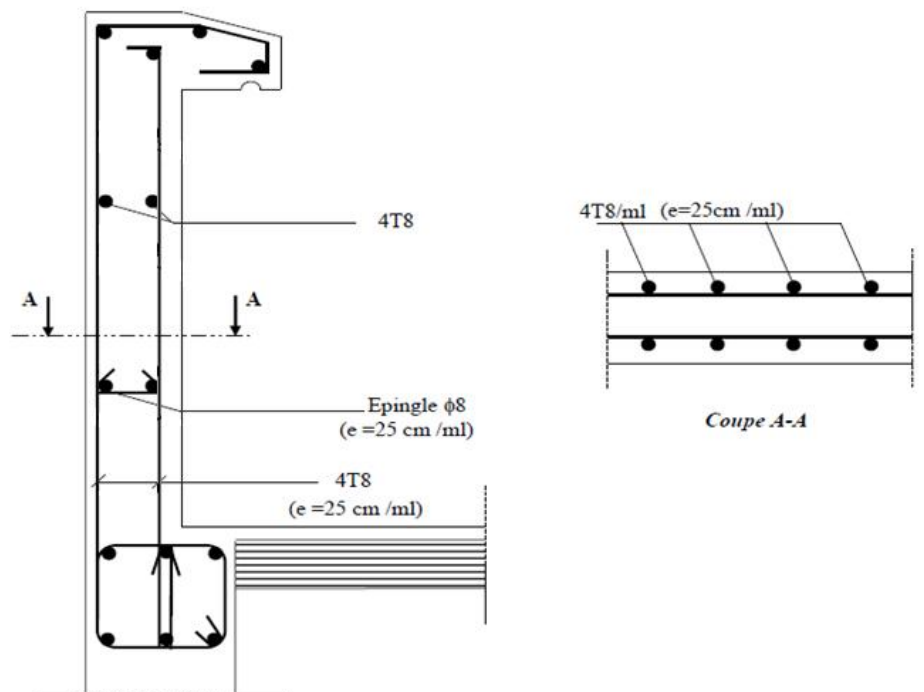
Coffrage et ferrailage de l'acrotère
